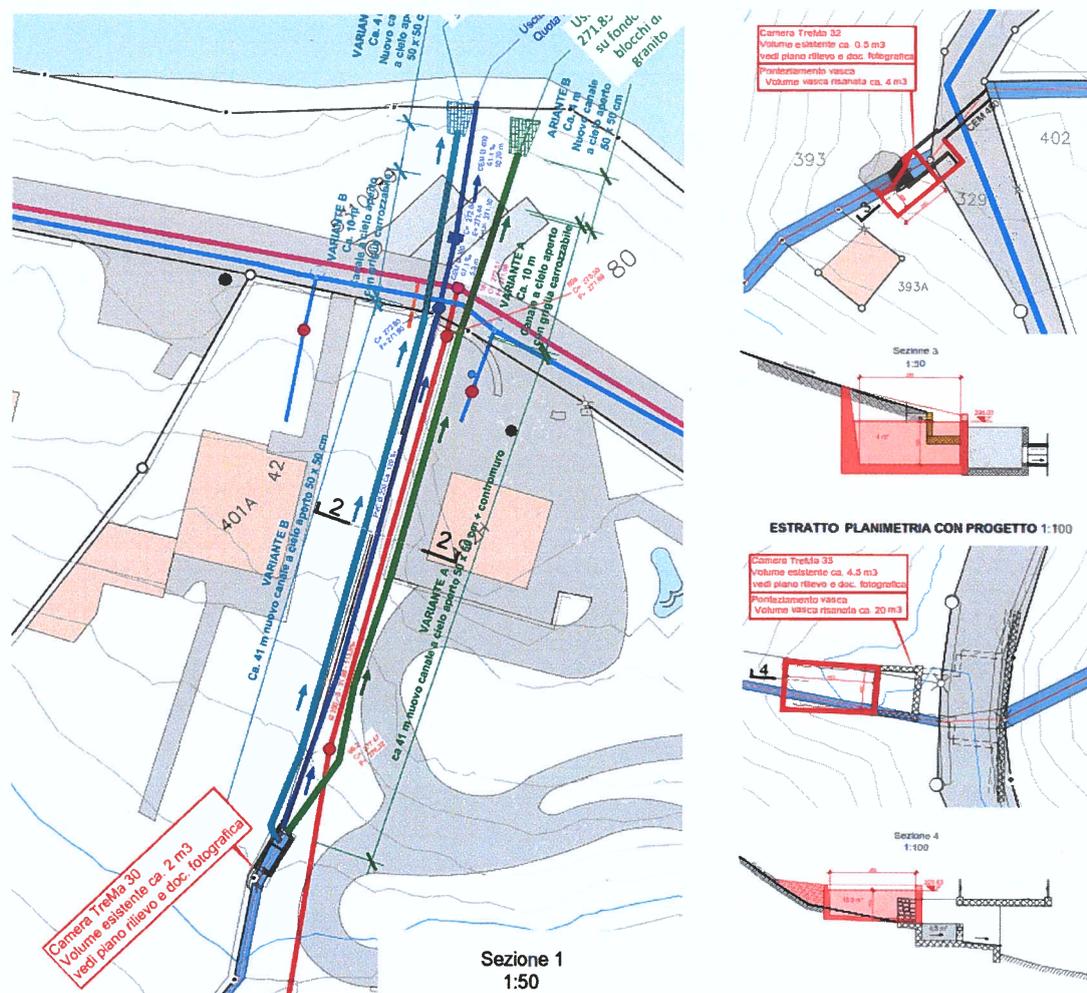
Estratto planimetria 020, intervento Area 2 a sinistra e interventi alle camere 33 e 32 TREMA a destra
